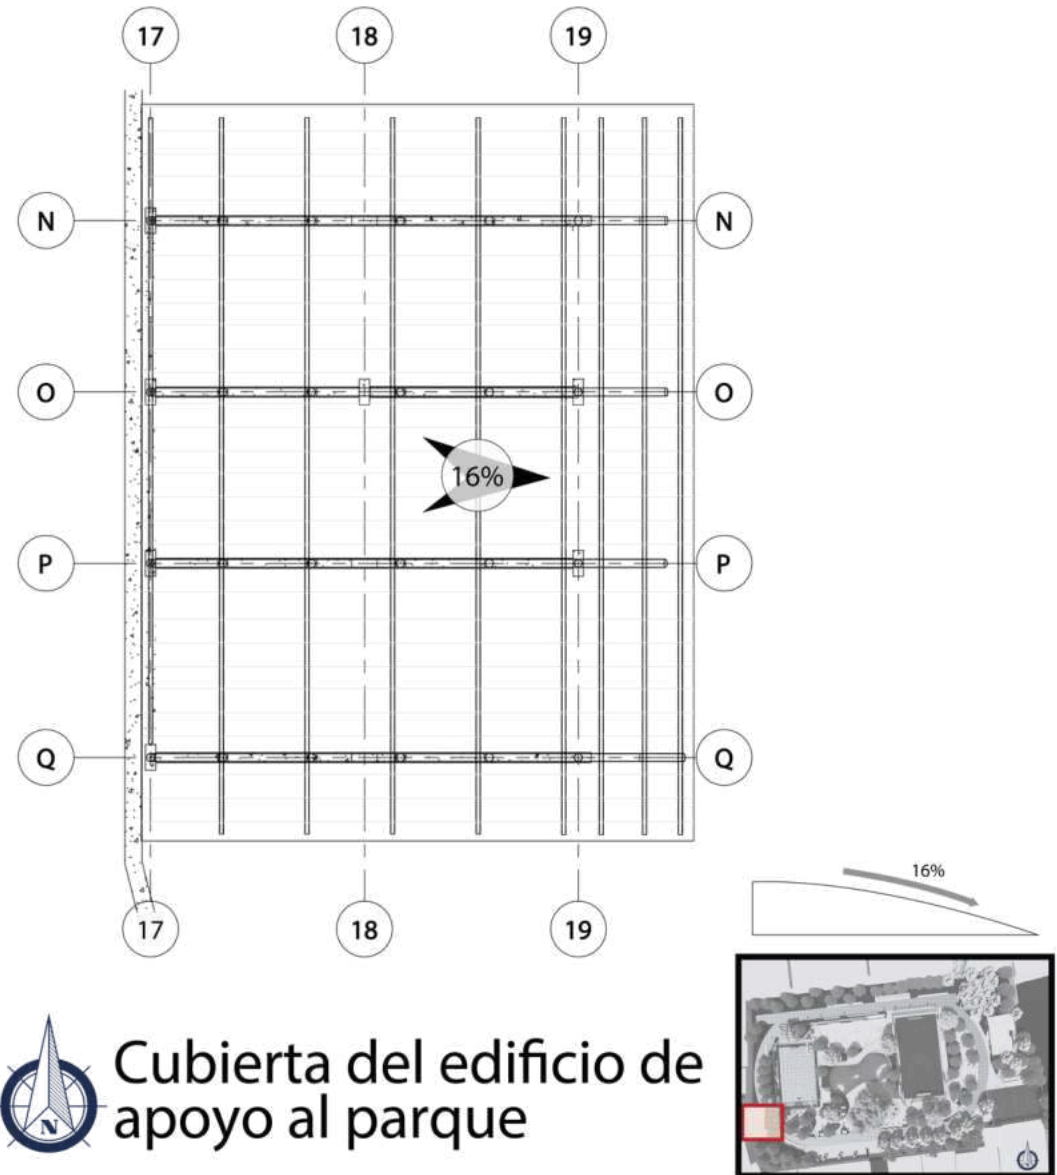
Planta de cubierta del edificio administrativo y de baños
